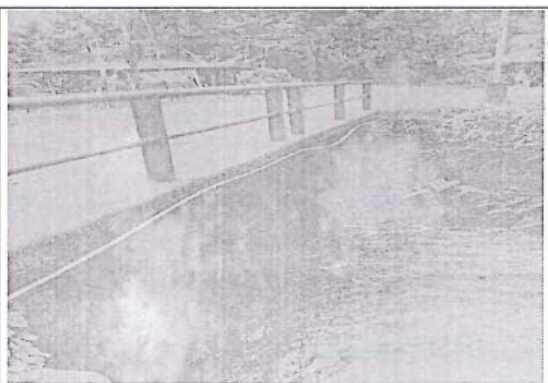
Vista aguas abajo del Puente Viga losa de L=10.00m en estado bueno, ubicado en la progresiva km 10+920.
